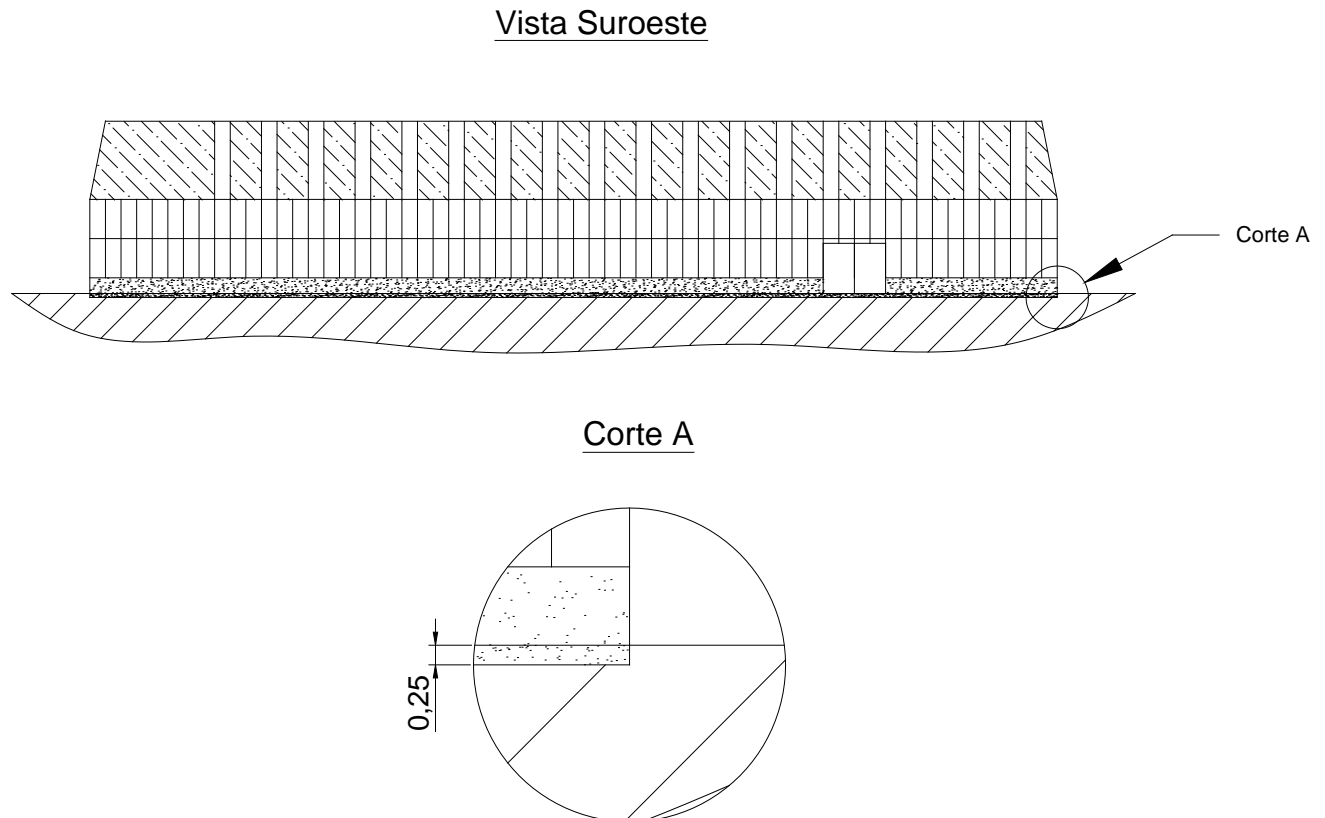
Corte en que se muestra la losa y su acotado.
